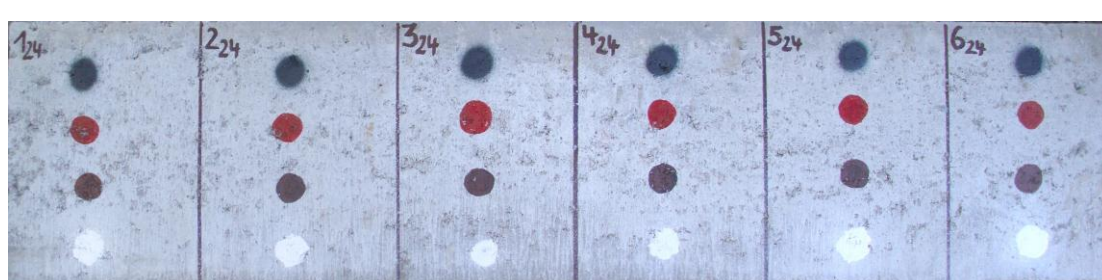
Prüfung auf ungeschütztem Betonuntergrund
